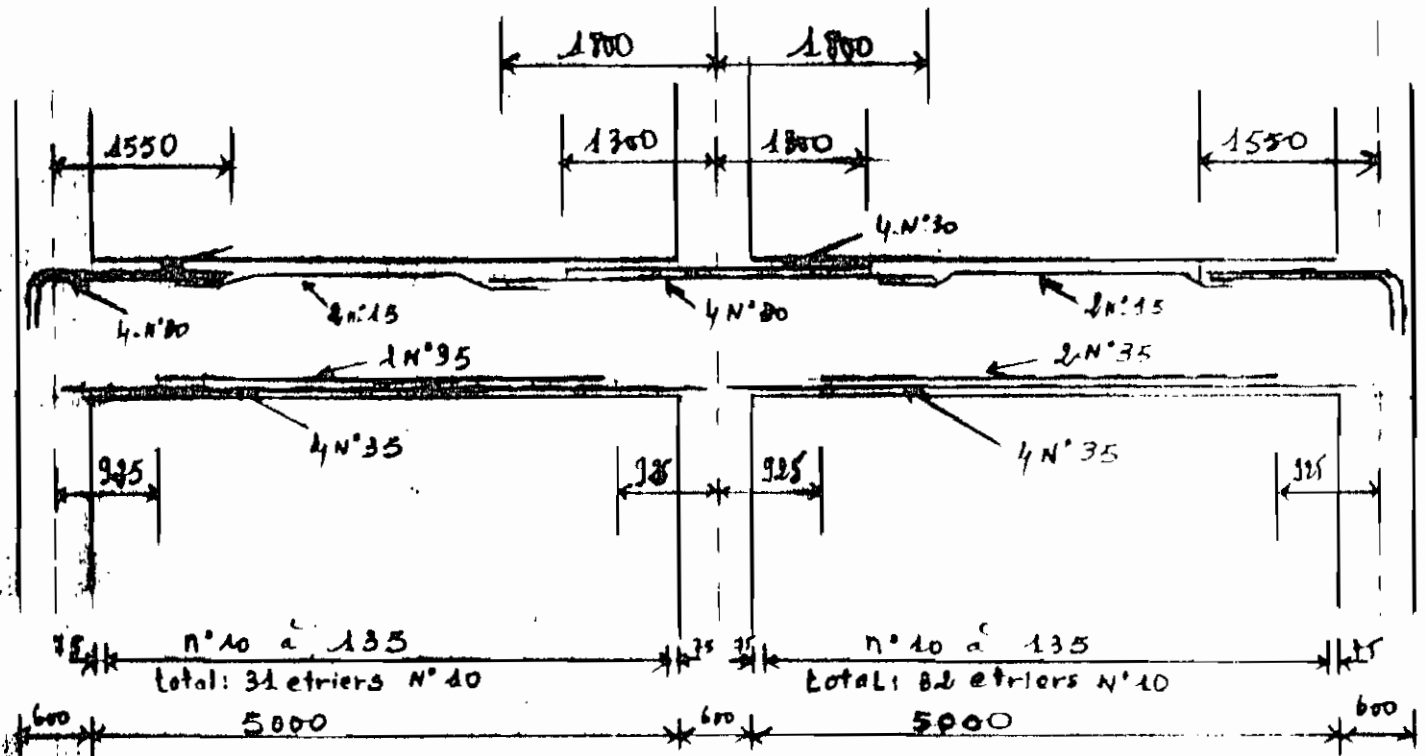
Schéma de ferrailage de la poutre secondaire.
